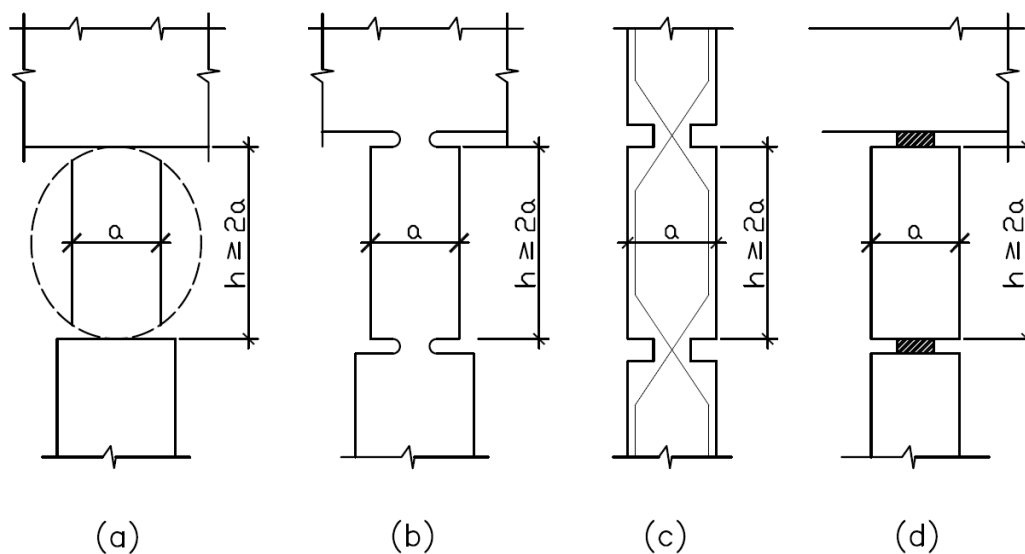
Tipos de aparelhos de apoio de articulação de concreto.
